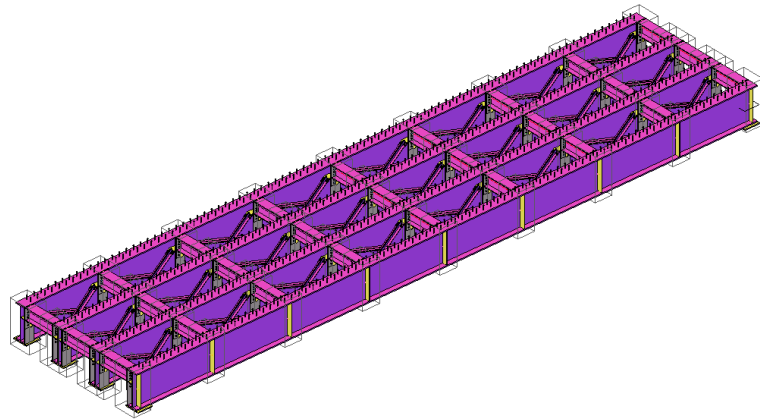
Vista 3D del modelo de la estructura de acero. Elaboración propia con Advance Steel.
